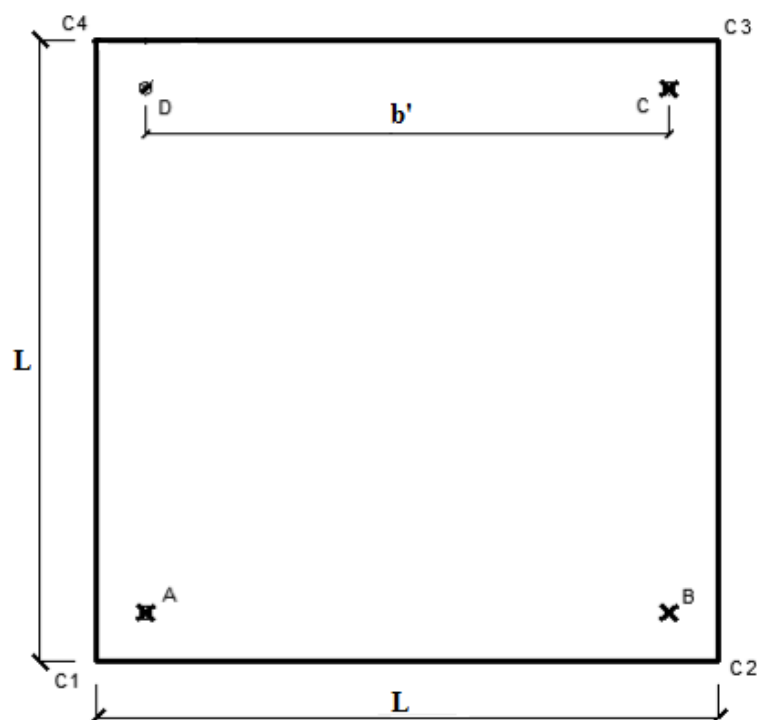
Dimensões e pontos de apoio/carga das lajes, adaptado de (Menoita, 2010).
